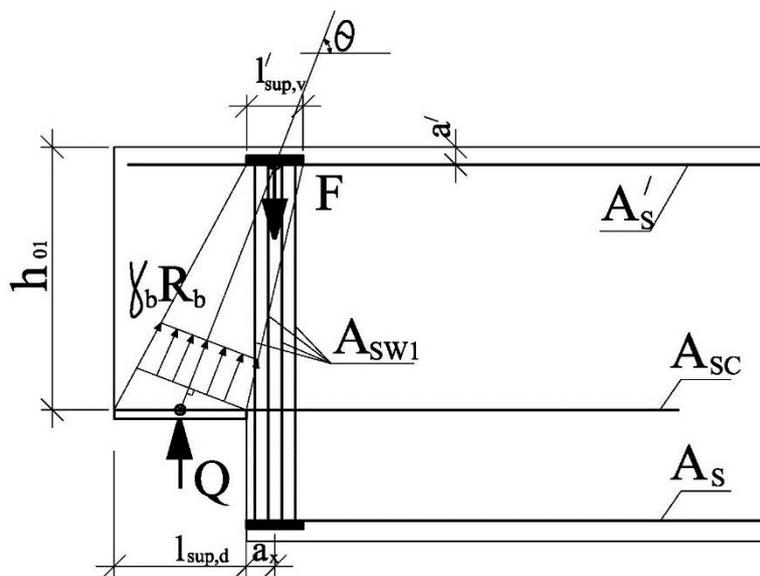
Стержневая модель сжатой полосы бетона короткой консоли ригеля между опорной и условной грузовой площадками
